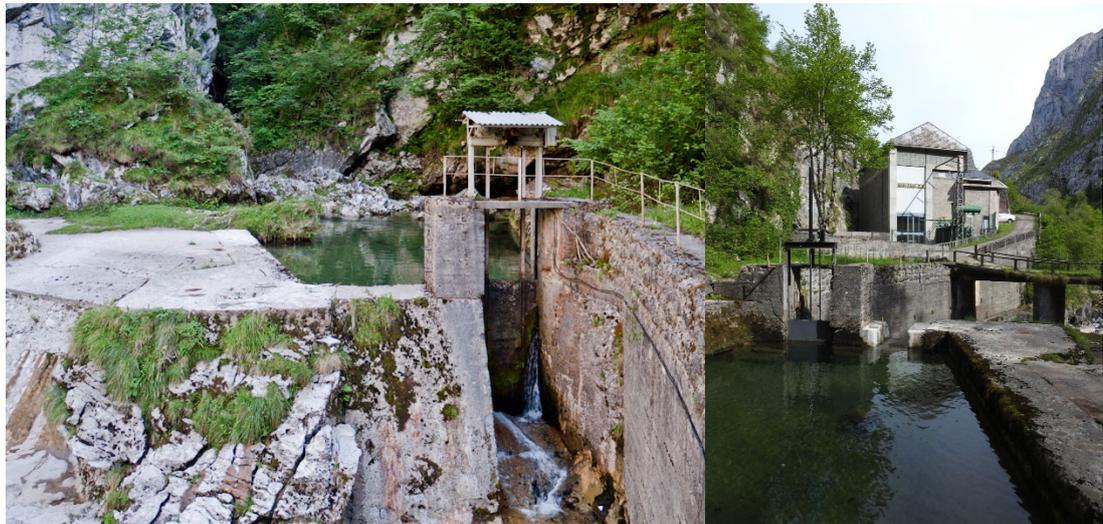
Detalle del azud de Restañó en el que se puede observar la compuerta tajadera para el vaciado (izquierda) y rebaje para satisfacer el caudal ecológico (derecha)
